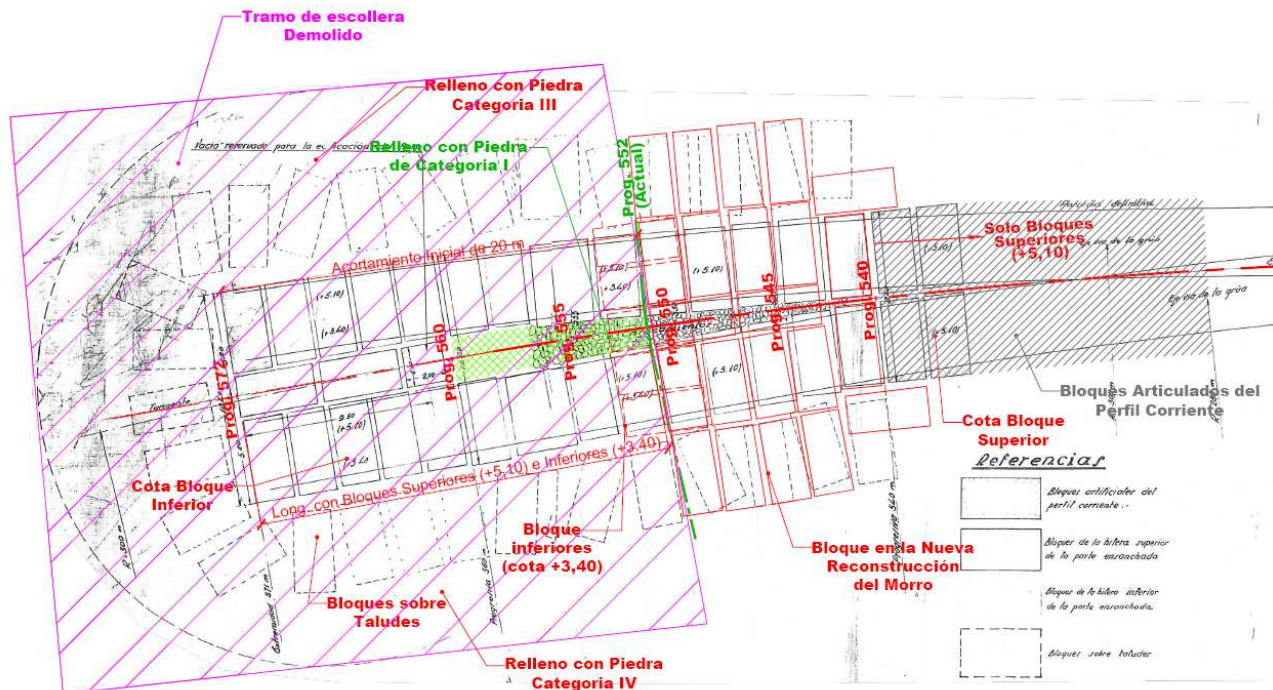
Detalle de escollera demolida, según plano 118-16-PM-21.
